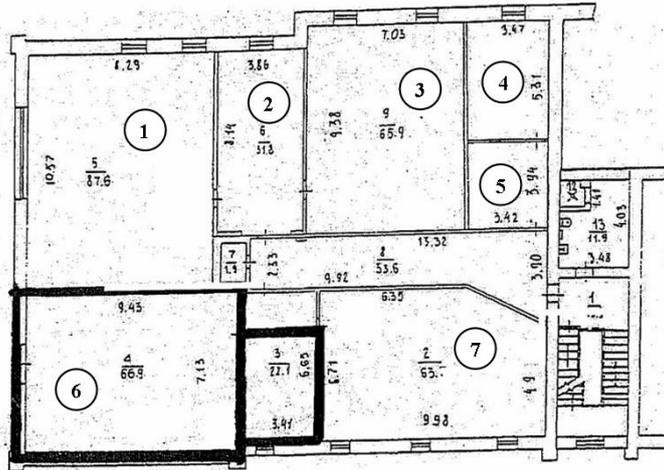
План поверху офісної будівлі за варіантом № 1
